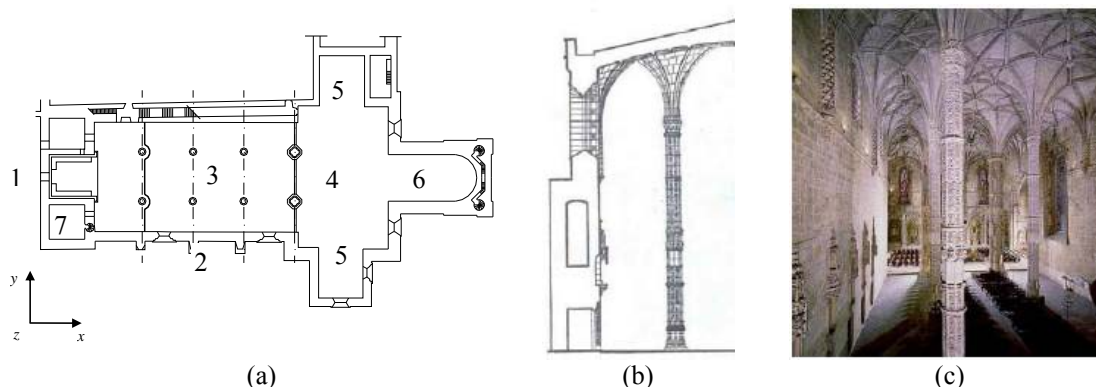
Igreja do Mosteiro dos Jerónimos: (a) planta (1-portal axial a Poente, 2-portal lateral, 3-nave, 4-transepto, 5-capelas laterais, 6- ábside; 7-torre sineira a Sul); (b) secção transversal da nave (metade Norte); (c) interior da nave vista do coro alto.
